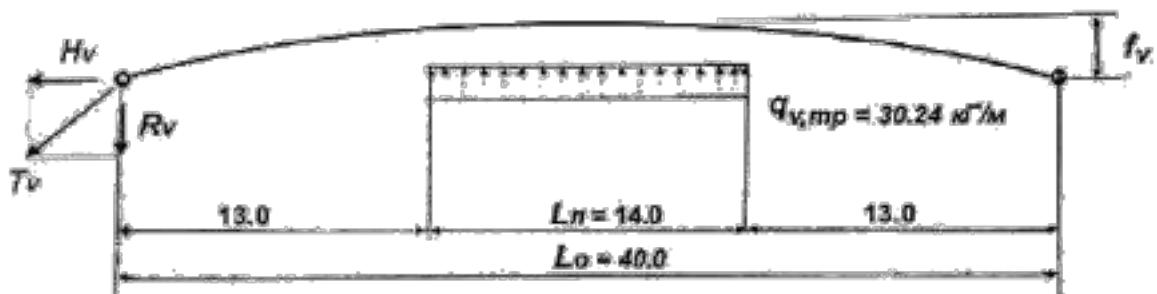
Расчетная схема нити для определения усилий от ветро-вой нагрузки на транспарант
